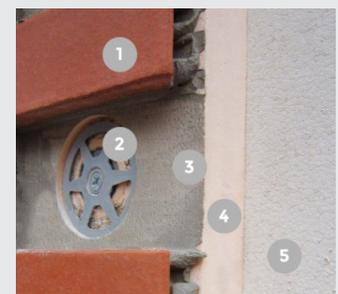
Solución constructiva de muro de una hoja con panel aislante con plaqueta cerámica vista
